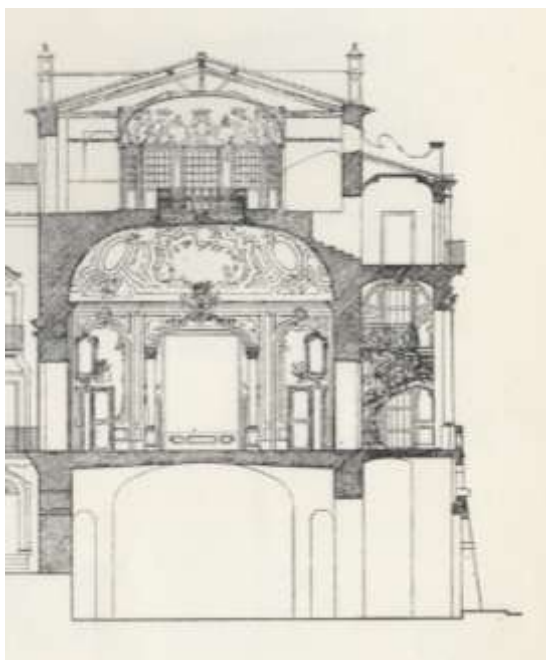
Sezione Longitudinale di Palazzo Biscari con individuazione della zona del salone al primo piano e della zona sottostante destinata a teatro.
